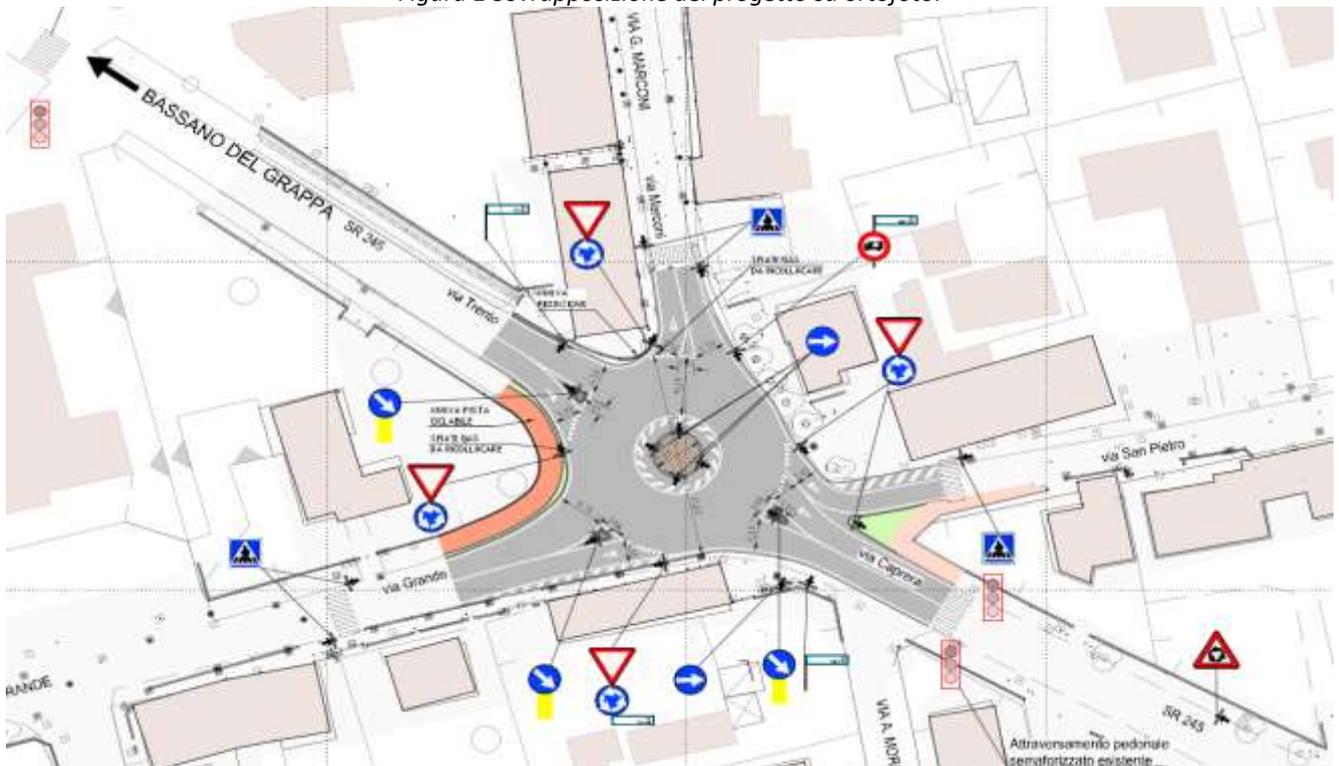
Planimetria di progetto con indicazione della nuova segnaletica.
